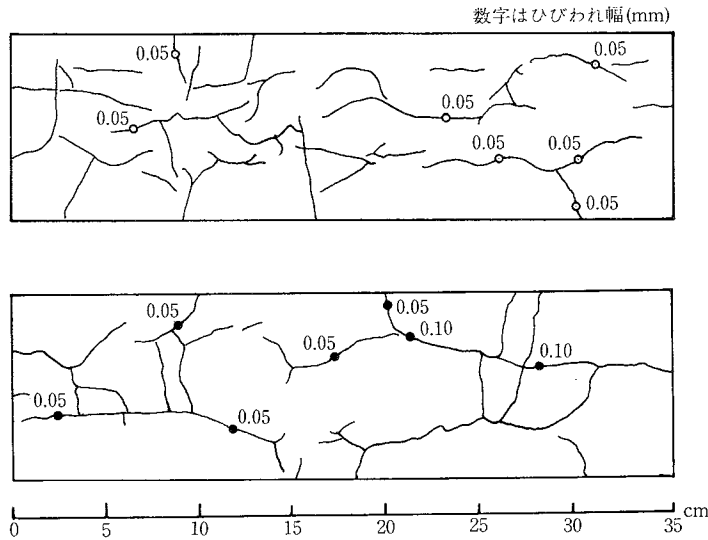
拘束試験体ひびわれ発生状況 (縦打ち)
